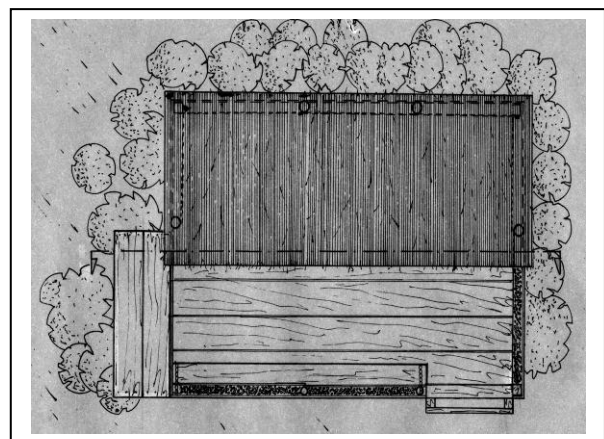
Tipico appostamento del Padule di Fucecchio. Vista dall'alto.
